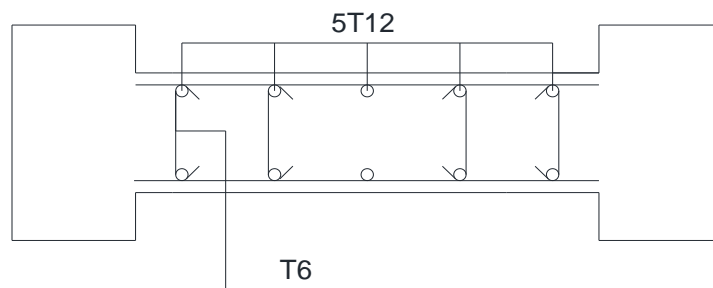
Schéma de ferrailage du voile (poutres normales - plan irrégulier en élévation)
